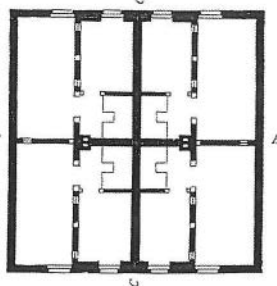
Der größere Typ des Vierfamilienhauses mit Kreuzgrundriss in einer leicht modifizierten Form der 1880er Jahre.
